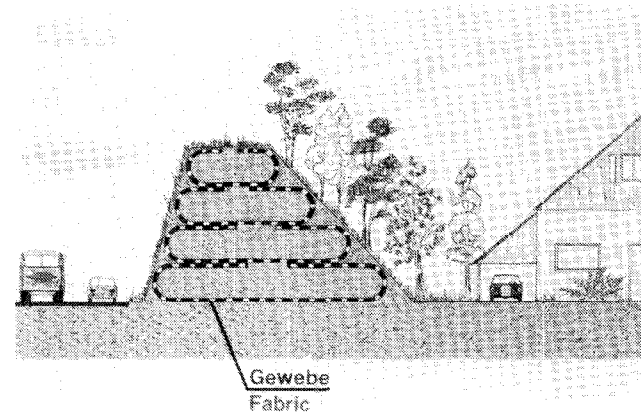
Straßenbau (Lärmschutzwall bei Rapperswil, CH)
